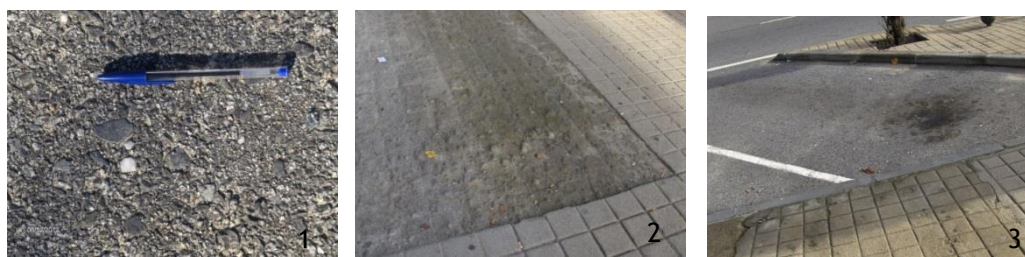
(1) Imagem do pavimento da faixa de rodagem; (2) Imagem do pavimento do passeio da; (3) Imagem do estacionamento
